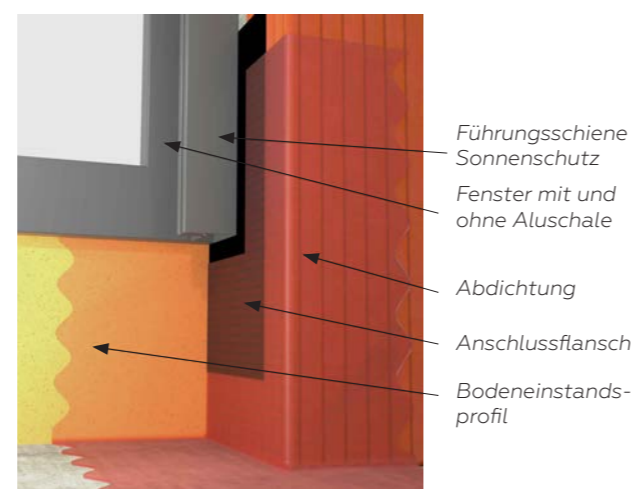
Prinzipskizze Fenster mit Sonnenschutzführungsschiene, Anschlussflansch und Abdichtung
